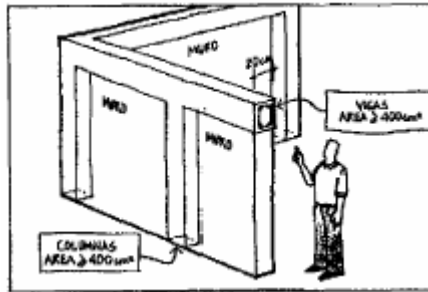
Vulnerabilidad Baja: Columnas y vigas de confinamiento.
